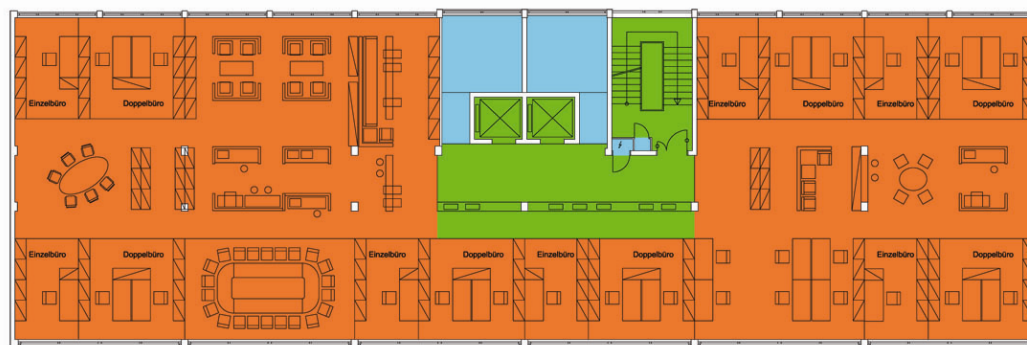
Grundrissstruktur Brandschutz für Bestand und Variante 2
